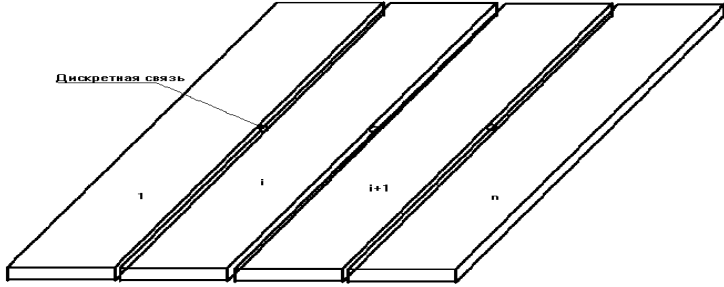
Схема сборного перекрытия с плитами, объединенными дискретными связями в середине пролета
